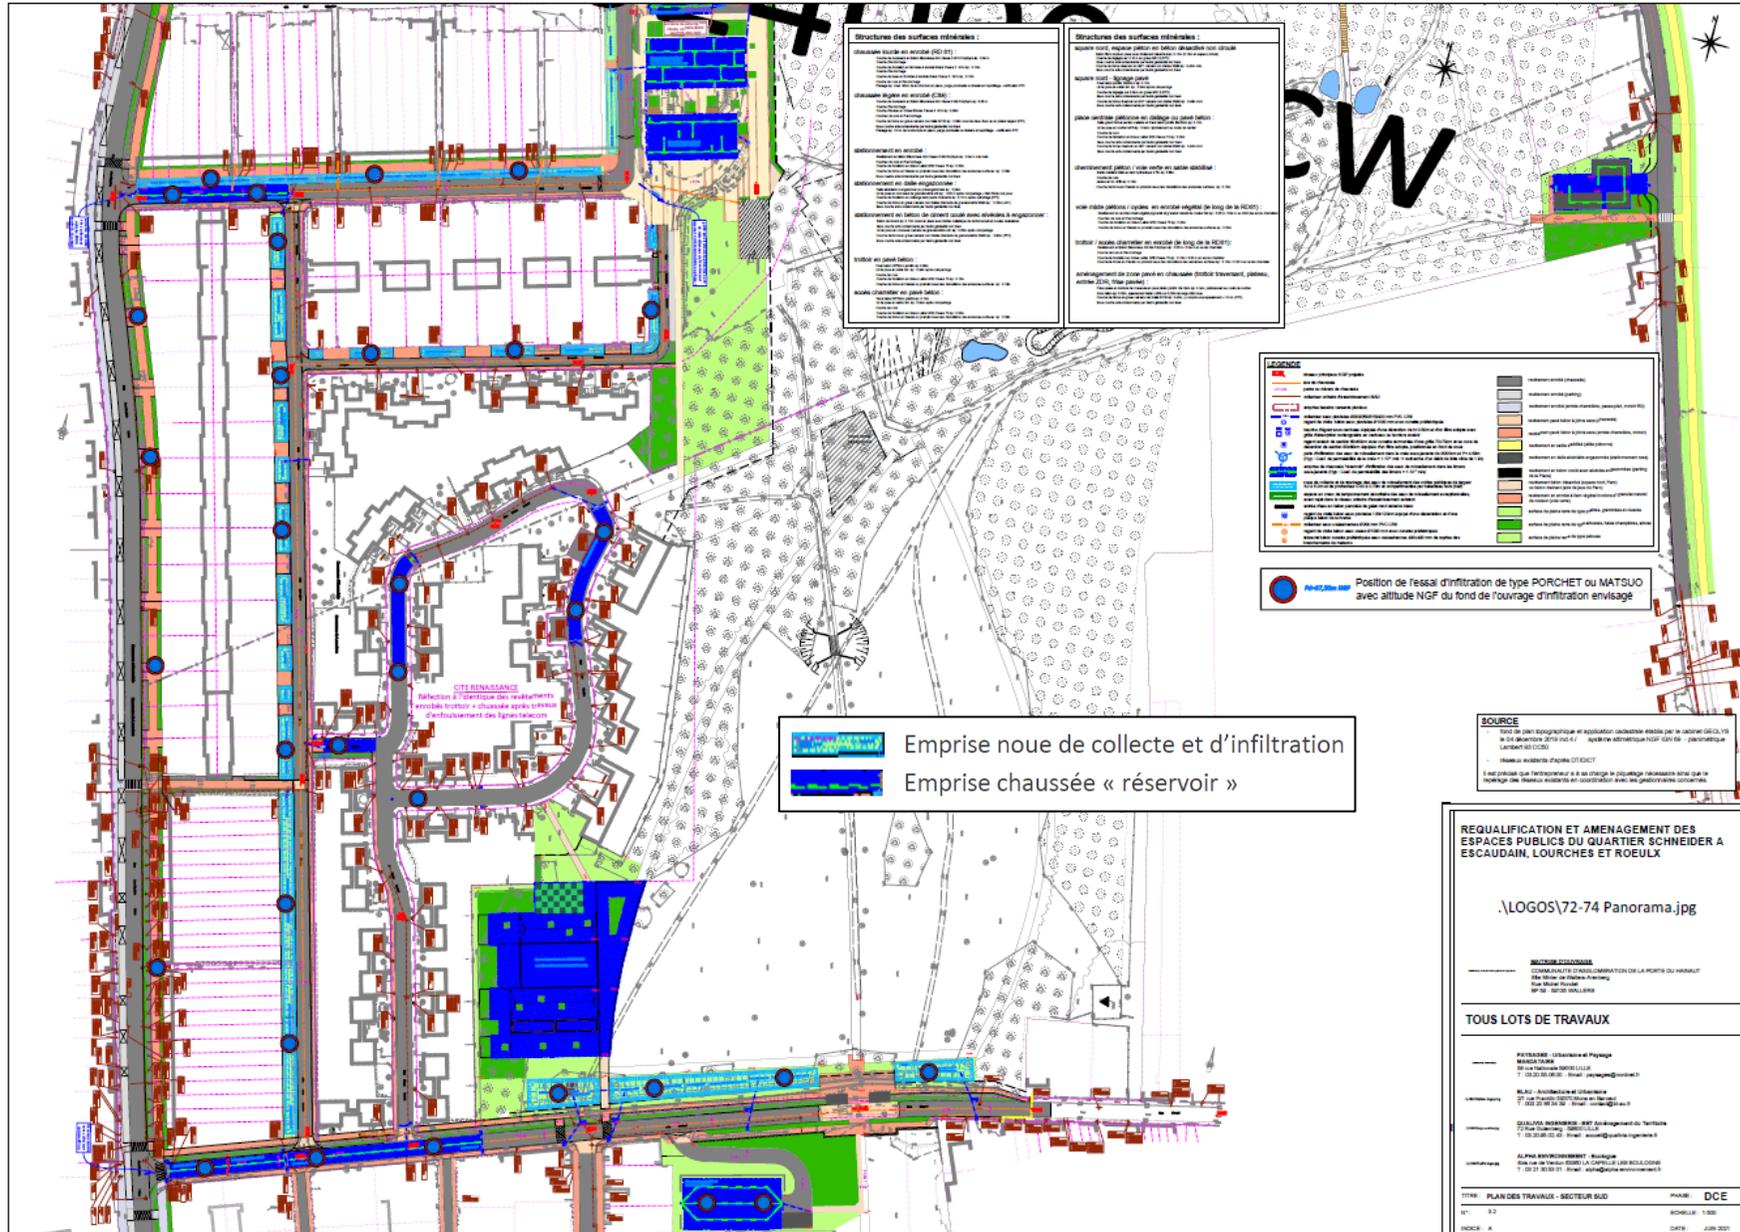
Plan masse du projet sur la zone « voiries et trottoirs » (source : CAPH)
